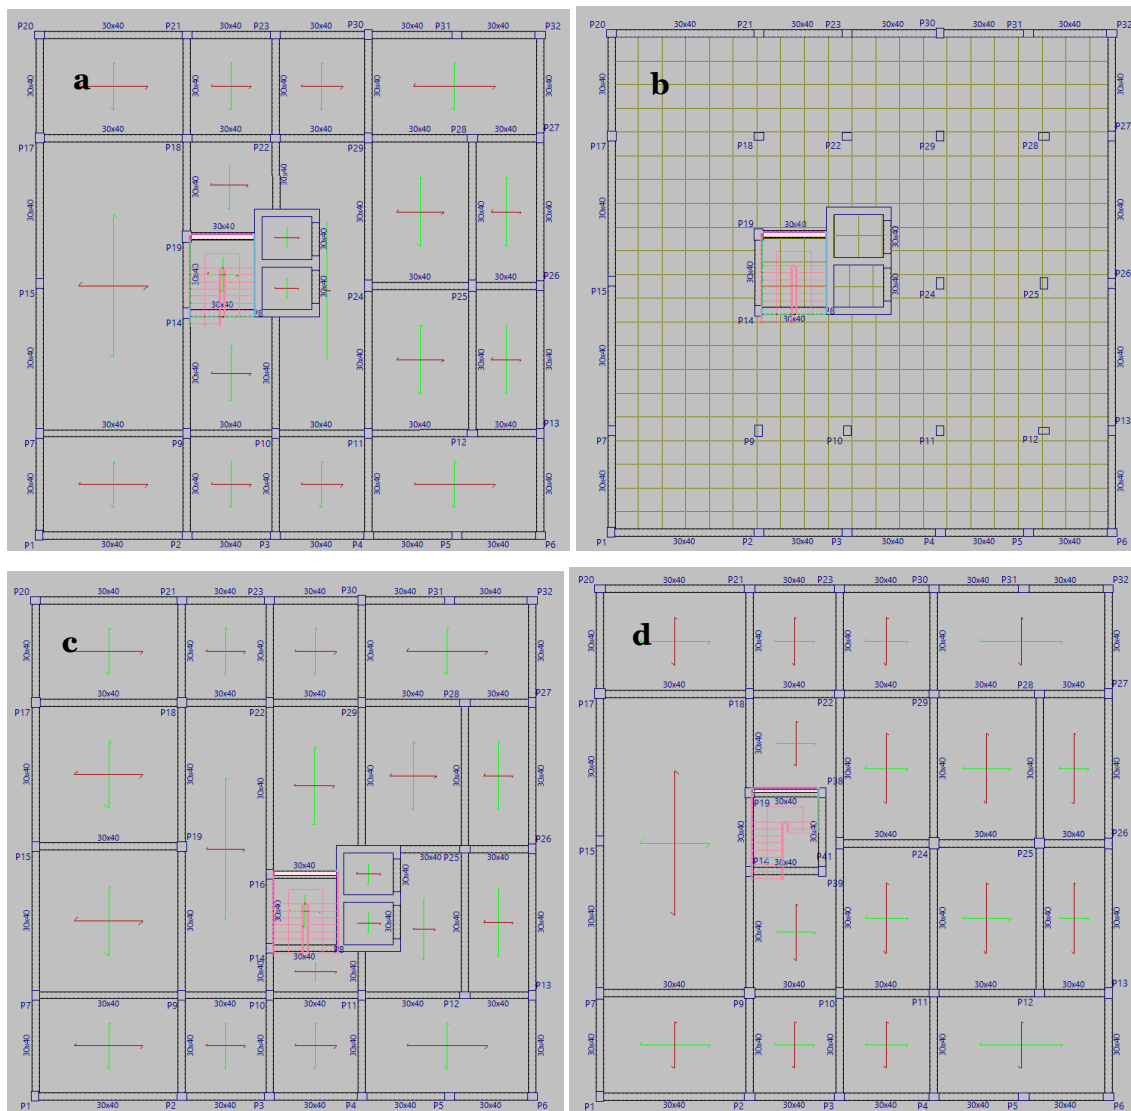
Modelos estruturais em planta. a) com laje maciça, b) com laje fungiforme, c) com caixa de elevador excêntrica e d) sem caixa de elevador.
